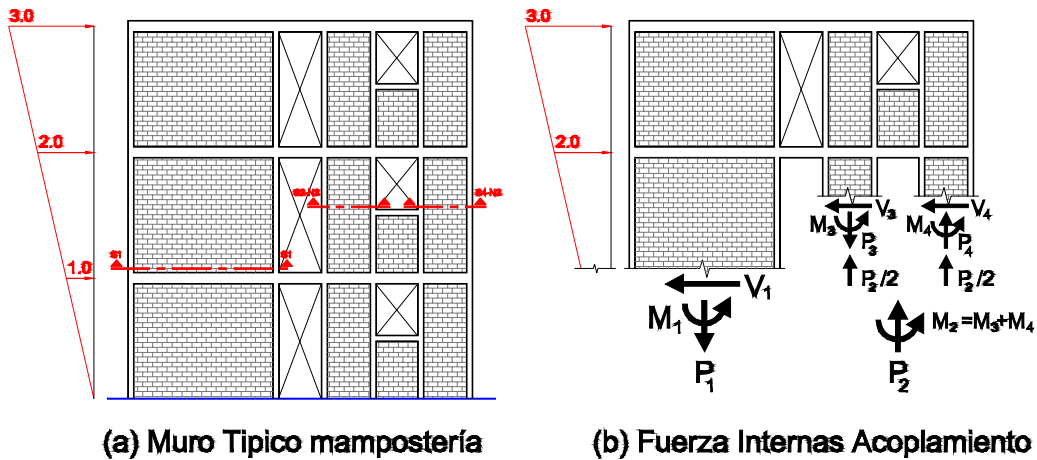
Acoplamiento muro típico mampostería confinada y elementos mecánicos
